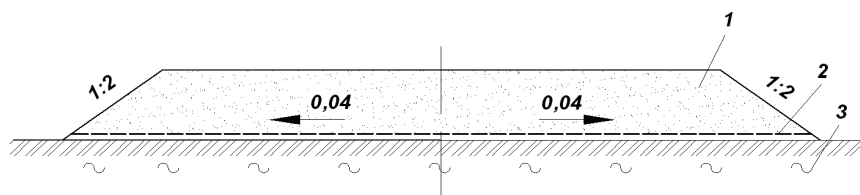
Конструкция насыпи с прослойкой из геотекстиля на участках переувлажненных грунтов:
